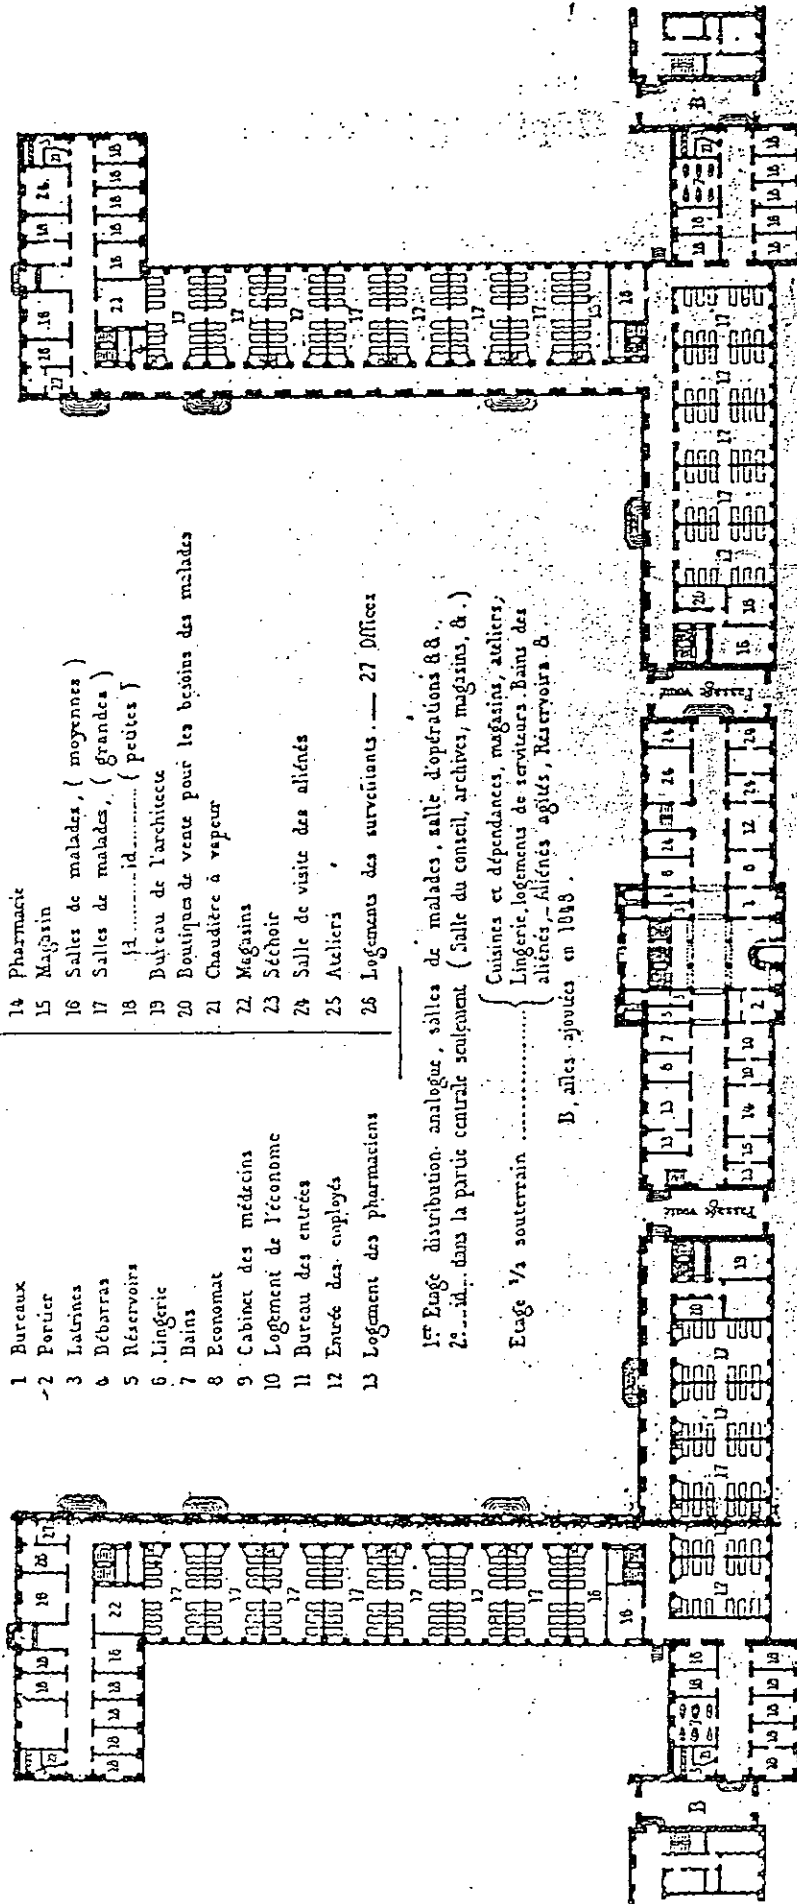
Bâtiment principal A du plan d'ensemble. Rez-de-chaussée.
